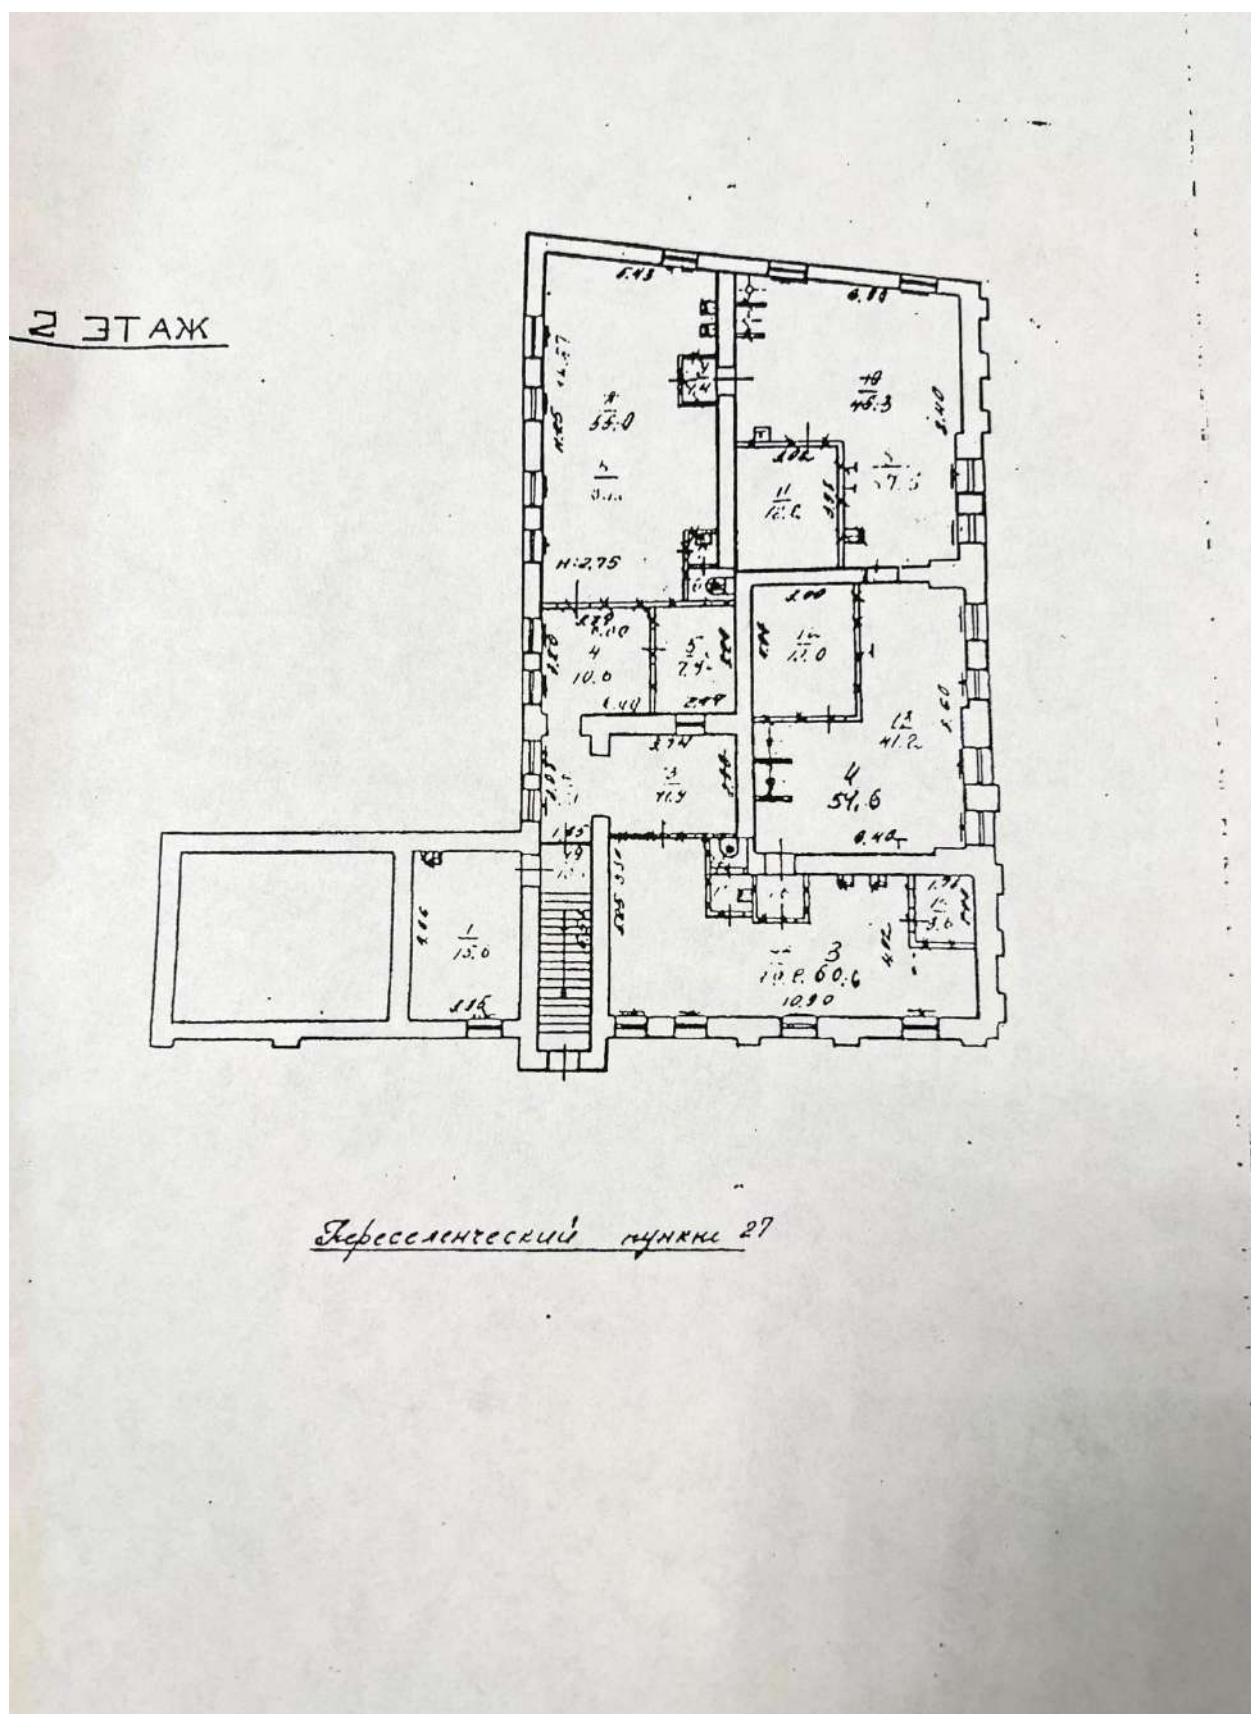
в. Технический паспорт здания бани (ул. Переселенческий пункт, 27) по состоянию на 1988 г. Поэтажный план. План второго этажа (литера «А»)
